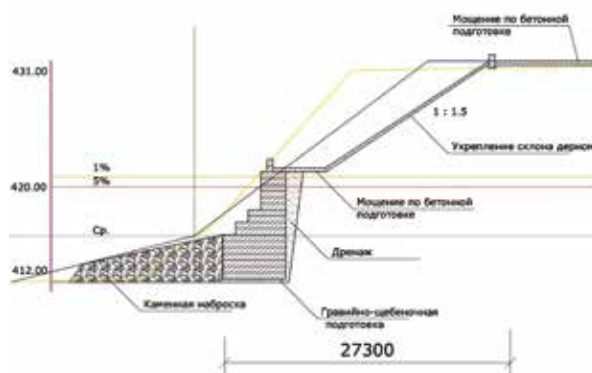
Разрез по берегоукреплению. Первый вариант, со сжатием русла и сохранением кромки берега
